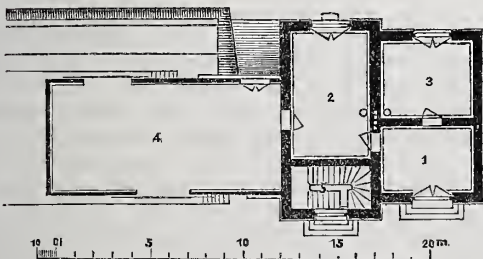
Grundriss vom Erdgeschoss.
